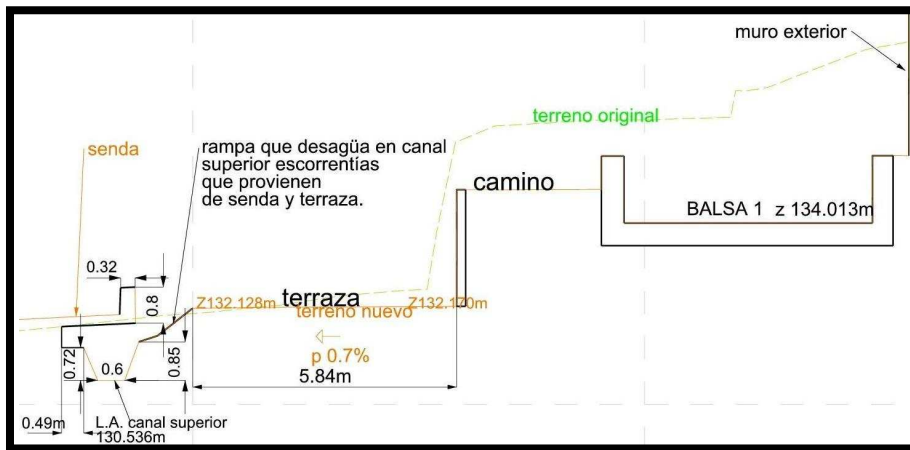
Detalle terraza con rampa desagüe.
